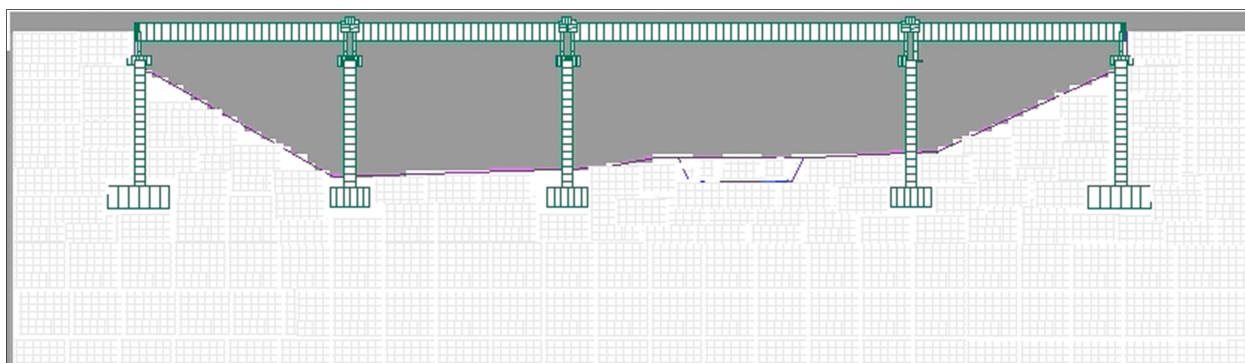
Сетка расчетной схемы путепровода и грунтового основания
